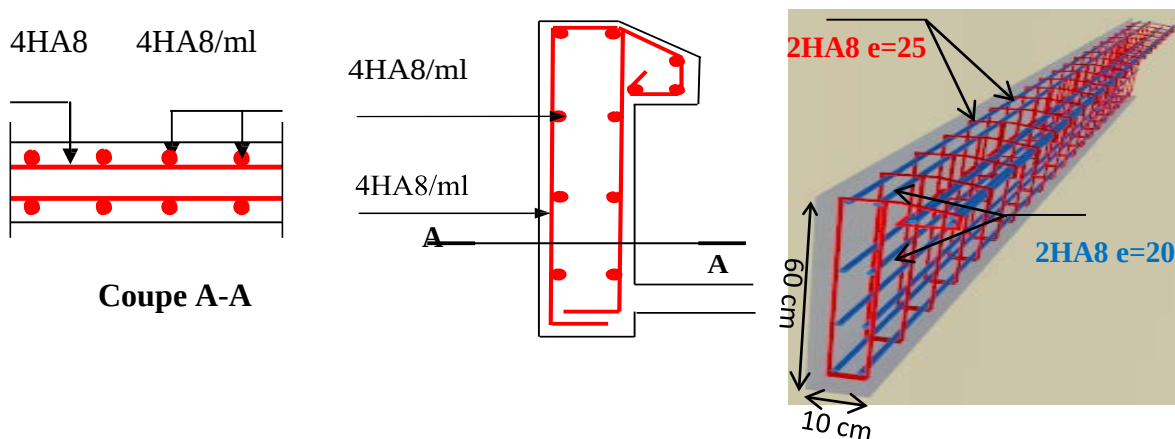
Schéma de ferrailage de l'acrotère.
